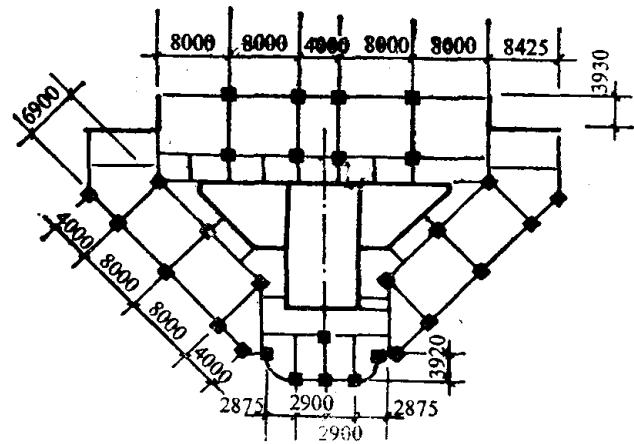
上海静安希尔顿饭店标准层平面 (43 层, 143.6m)
